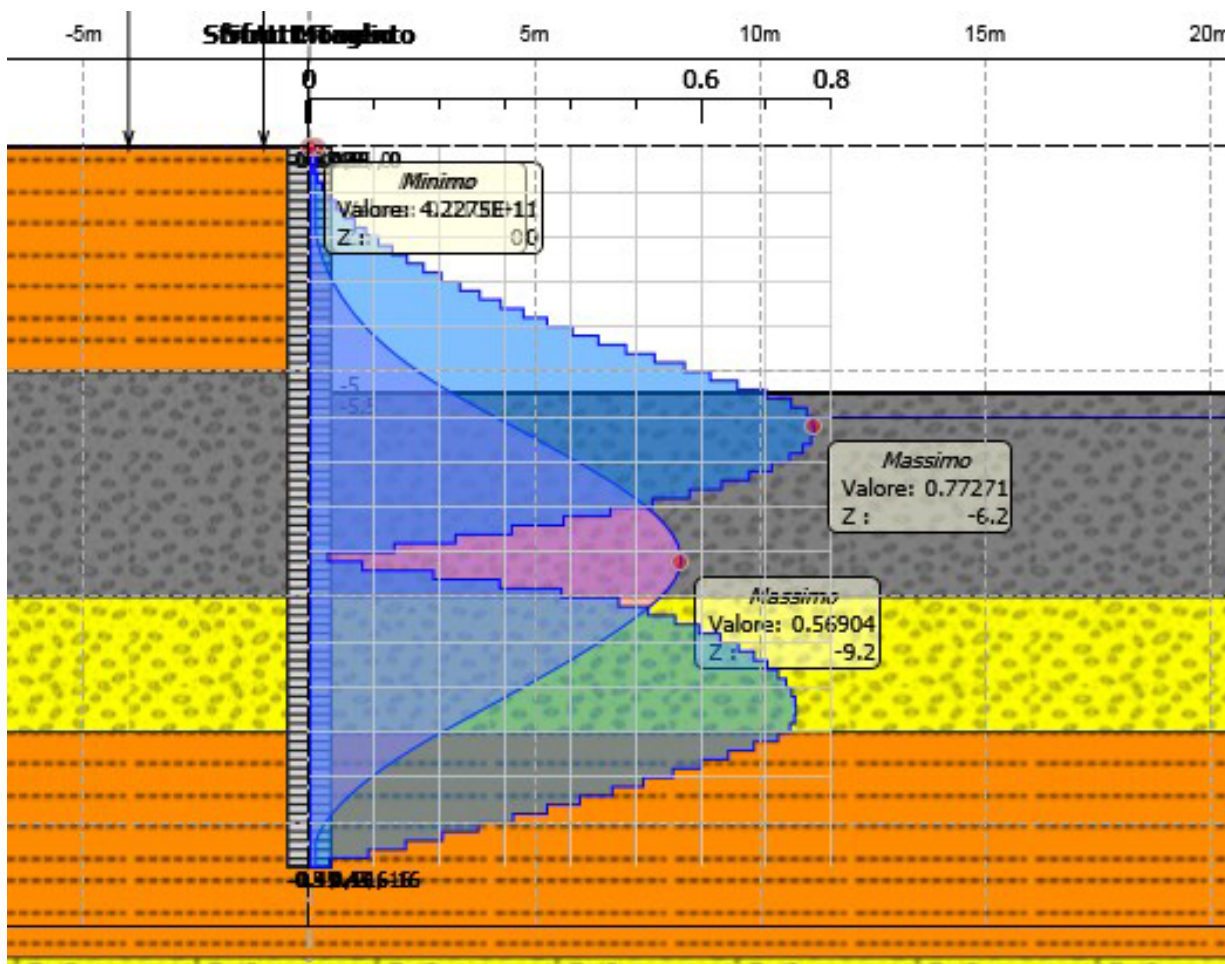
Pila 1 e 2 - coefficiente di sfruttamento sugli elementi strutturali – Verifica SLU (A2+M2+R1)
